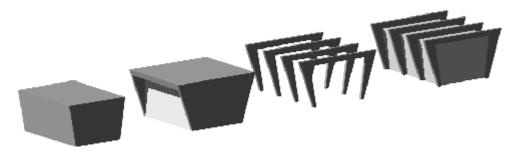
a) plano inclinado da fachada, b) empenas inclinadas na fachada, c) elementos estruturais inclinados e d) combinação de (a) e (c).
